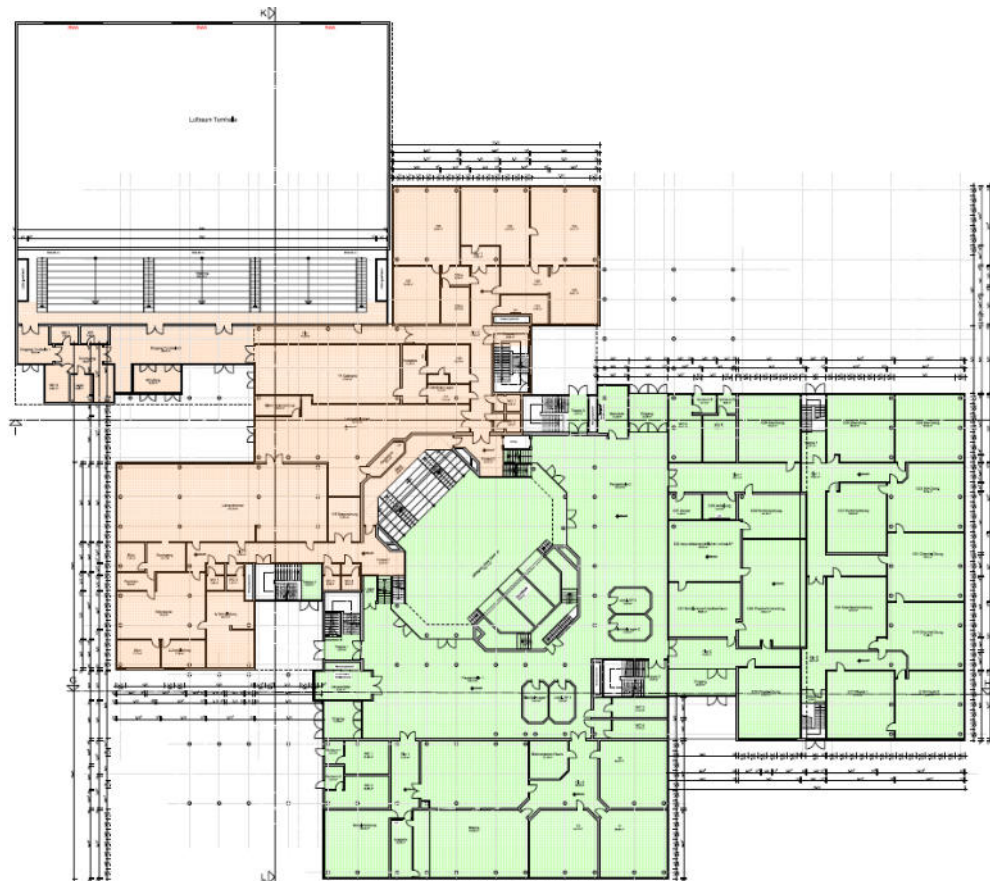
Grundrissausschnitt Erdgeschoss (Quelle: Mikler Architektur & Planung, Stand: 26.01.2021)
